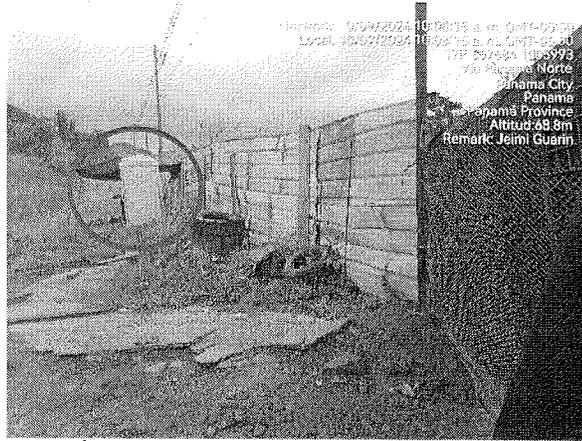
Área en donde ya se encajono el cauce hídrico y/o drenaje que atraviesa el proyecto hasta llegar al terreno colindante (Paseo del Norte).
